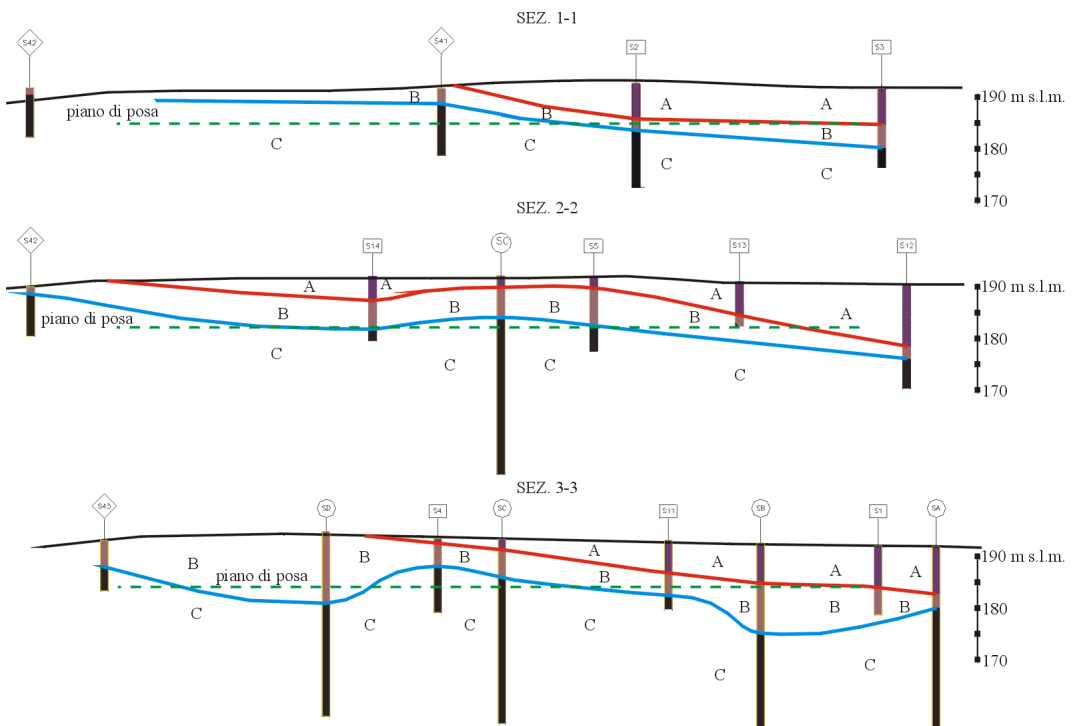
Profili geotecnici tracciati rispetto a tre sezioni longitudinali dell'Ospedale
